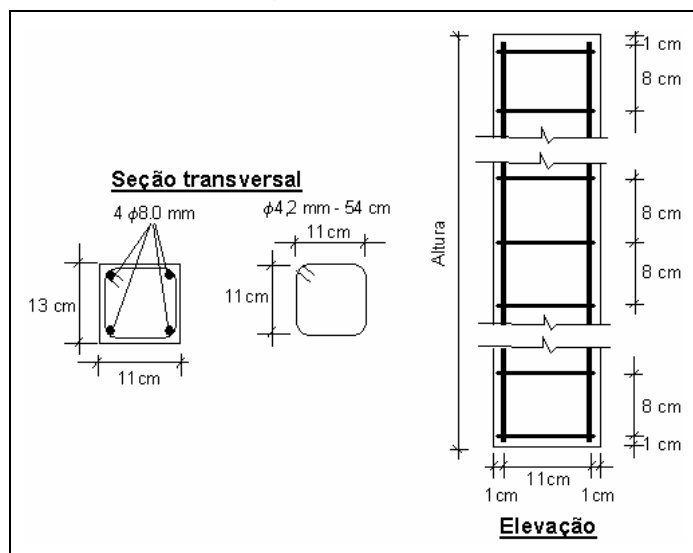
Detalhes da geometria e disposição das armaduras dos pilares.
